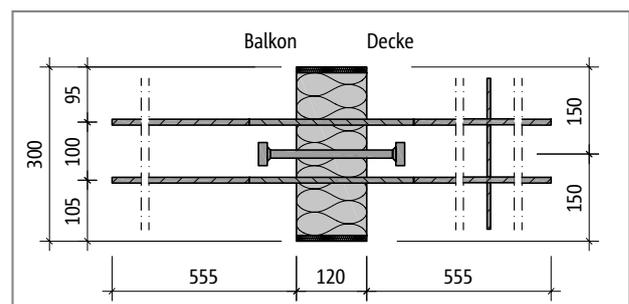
Schöck Isokorb® Typ QPXT10 bei REI120: Produktgrundriss; Brandschutzplatten seitlich
